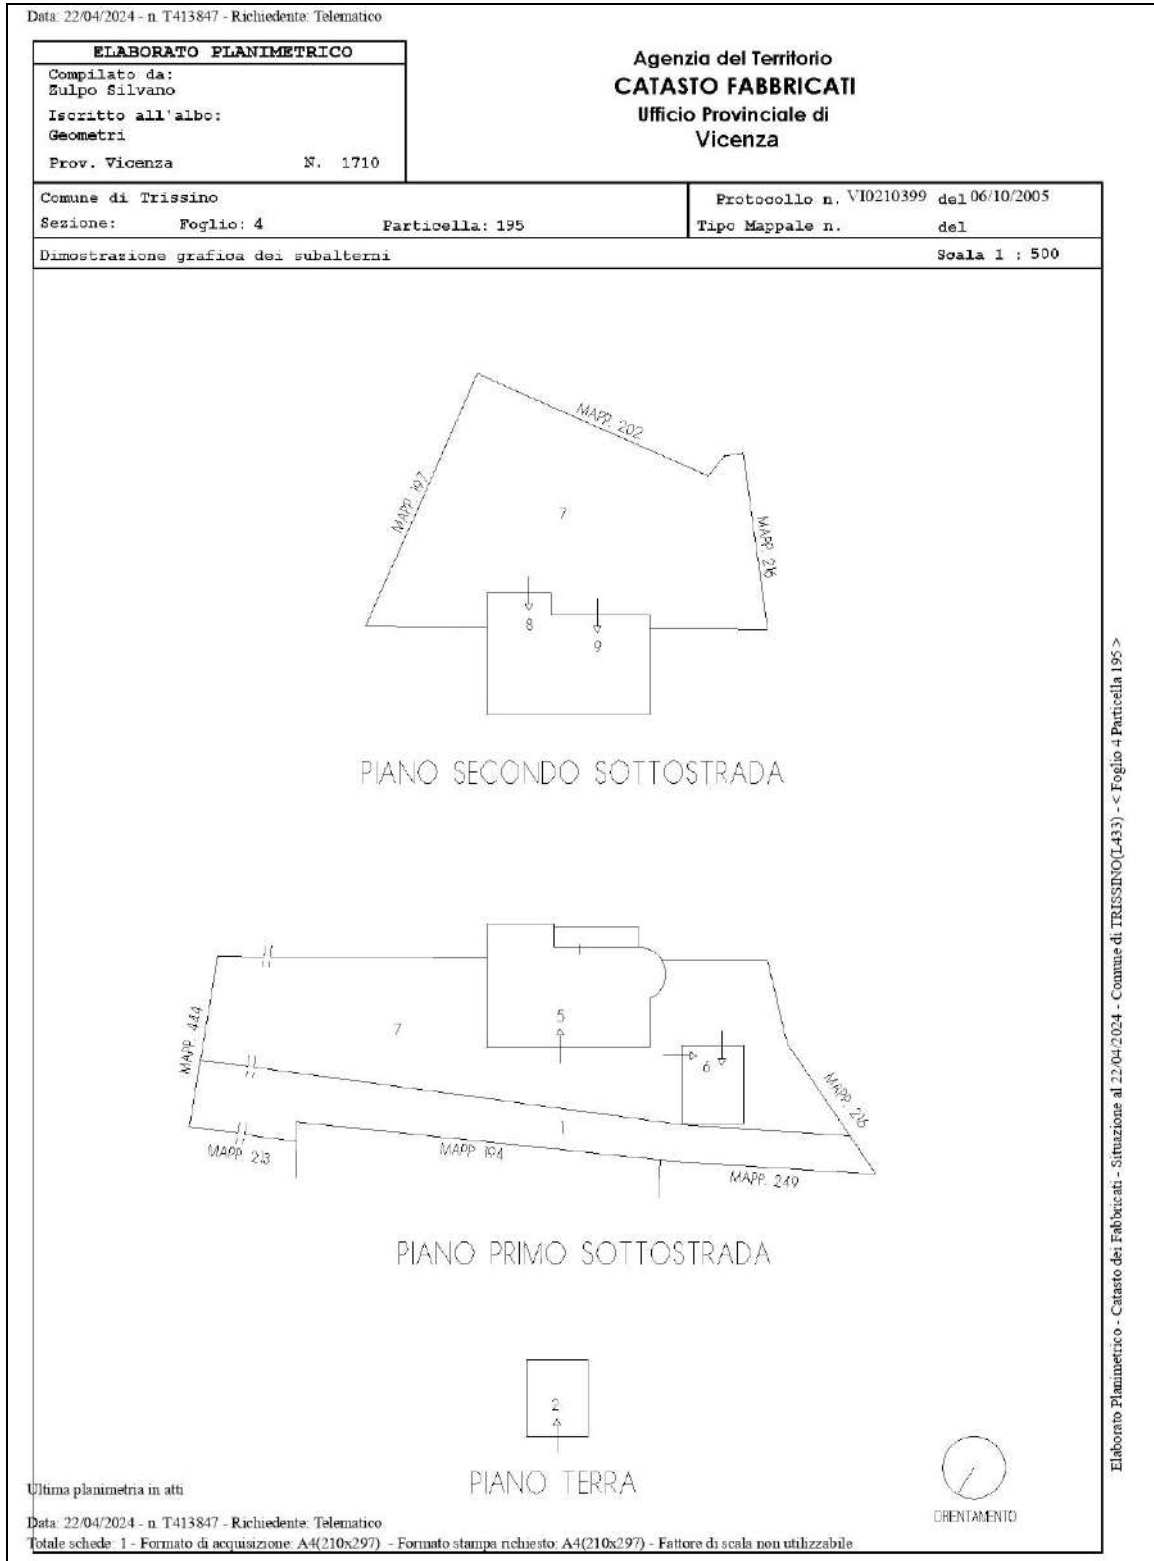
a. Elaborato Planimetrico - Foglio 4 mappale 195.
